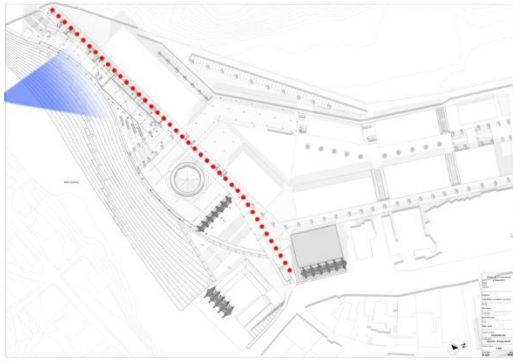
Plano de referencia vista hacia las fachadas del Hotel. Elaboración propia (2016)
